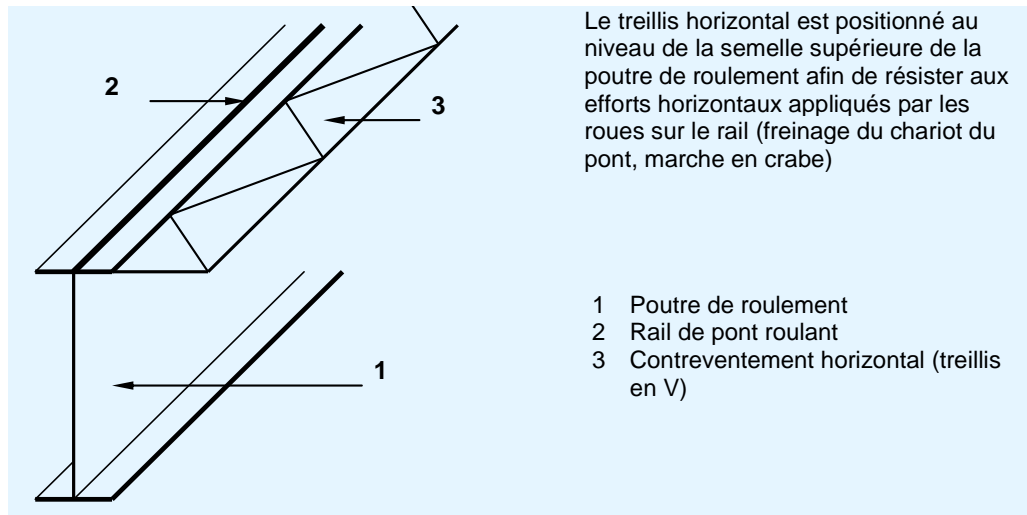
Contreventement horizontal pour une poutre de roulement
